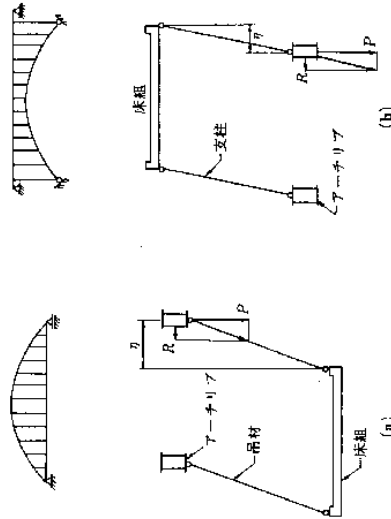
面外座屈時の吊材・支柱の作用
